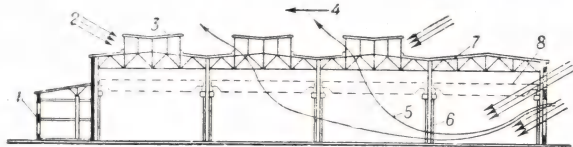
Вертикальный поперечный разрез (схема) одноэтажного многопролётного пром. здания: 1 — пристройка для бытовых помещений; 2 — направление светового потока; 3 — фонарь верхнего света; 4 — направление ветра; 5 — воздушные токи; 6 — колонна каркаса; 7 — покрытие; 8 — мостовой кран.
